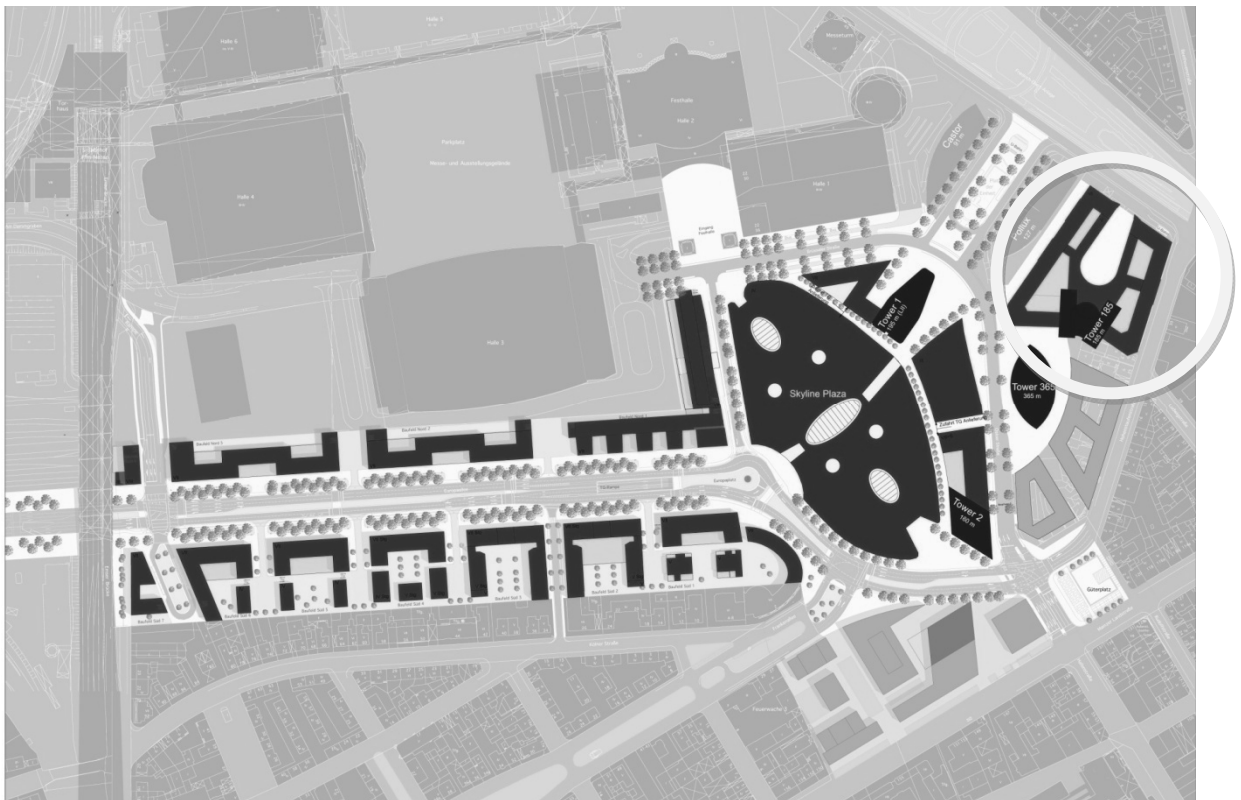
Masterplan Europaviertel Frankfurt mit Tower 185
